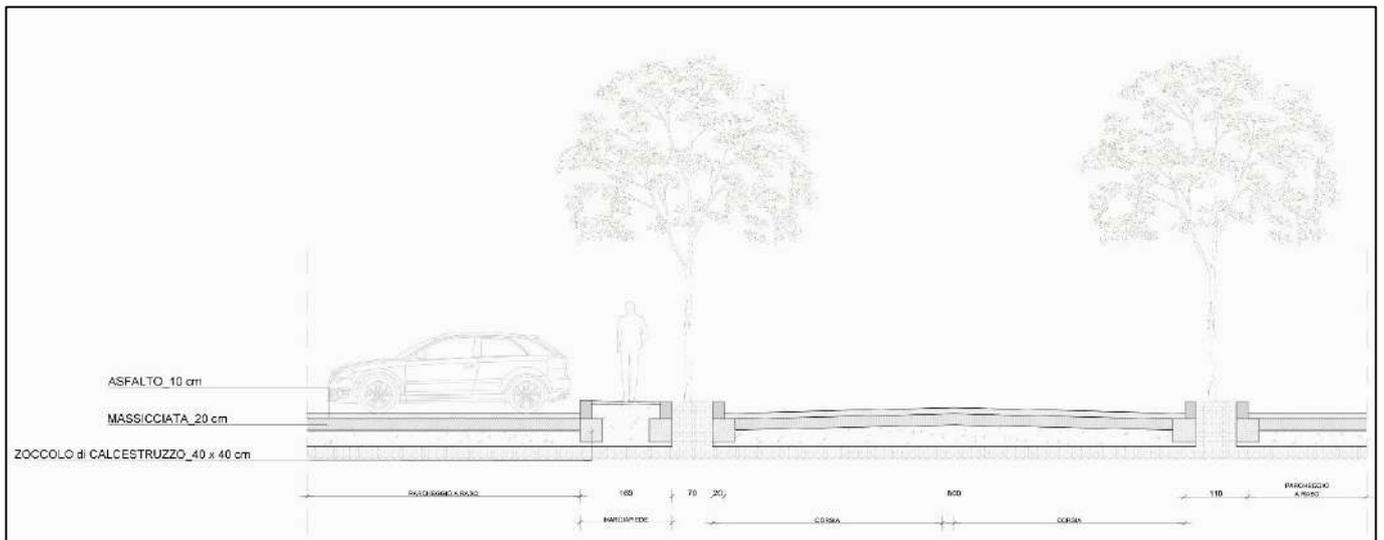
SEZIONE T.3 SUB-AMBITO B.2
